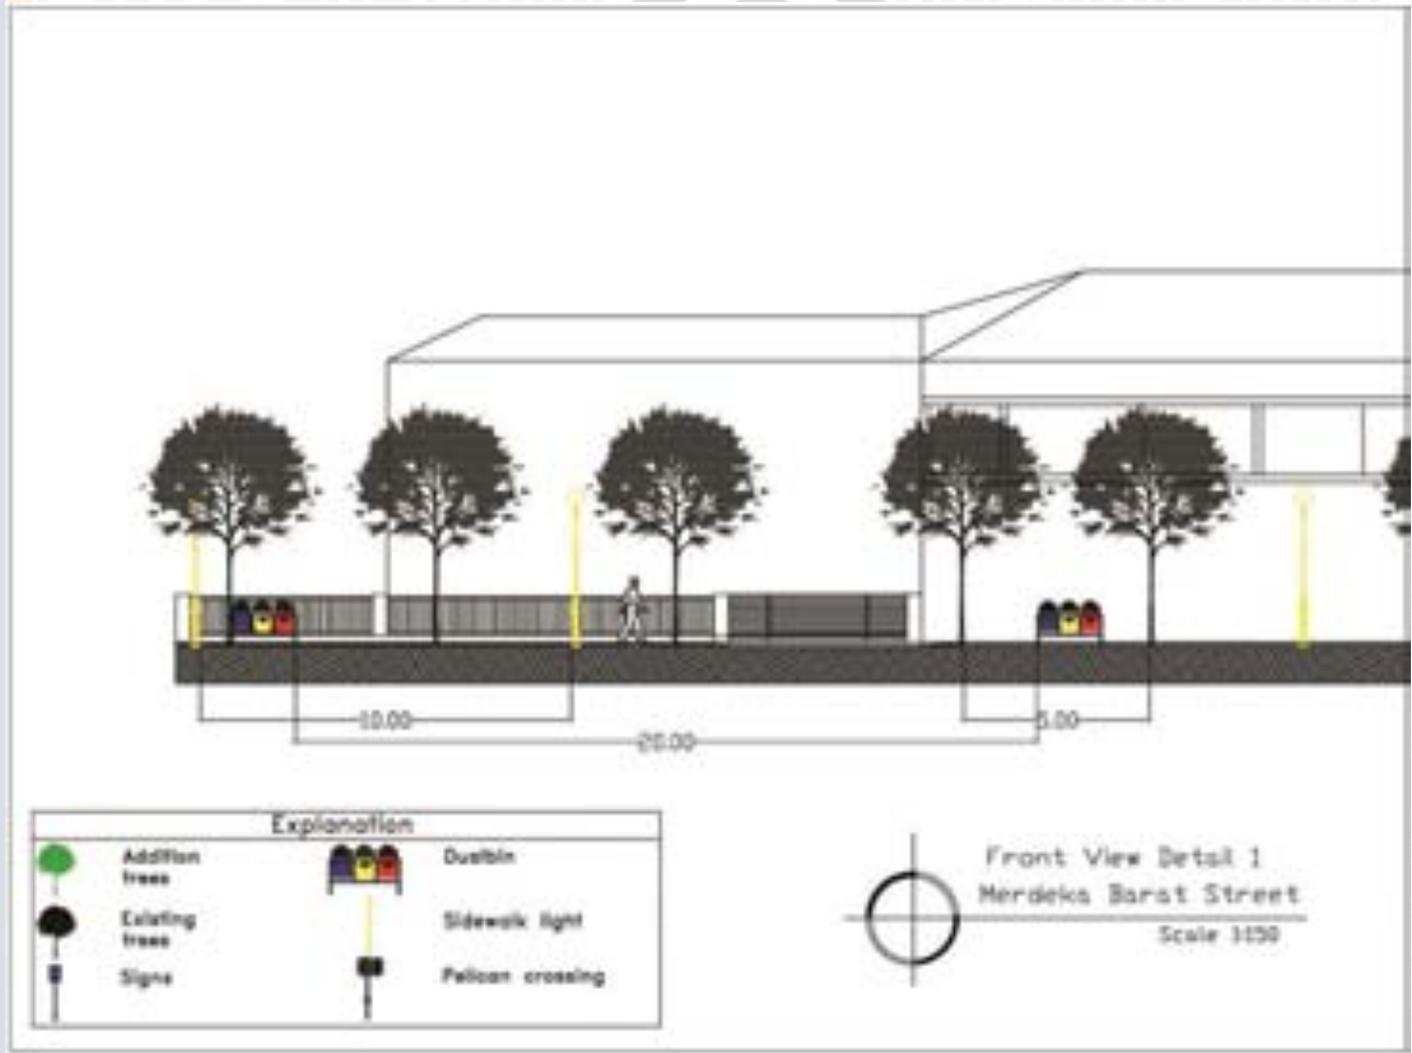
67 Penampang Tampak Atas Jalan Merdeka Barat
